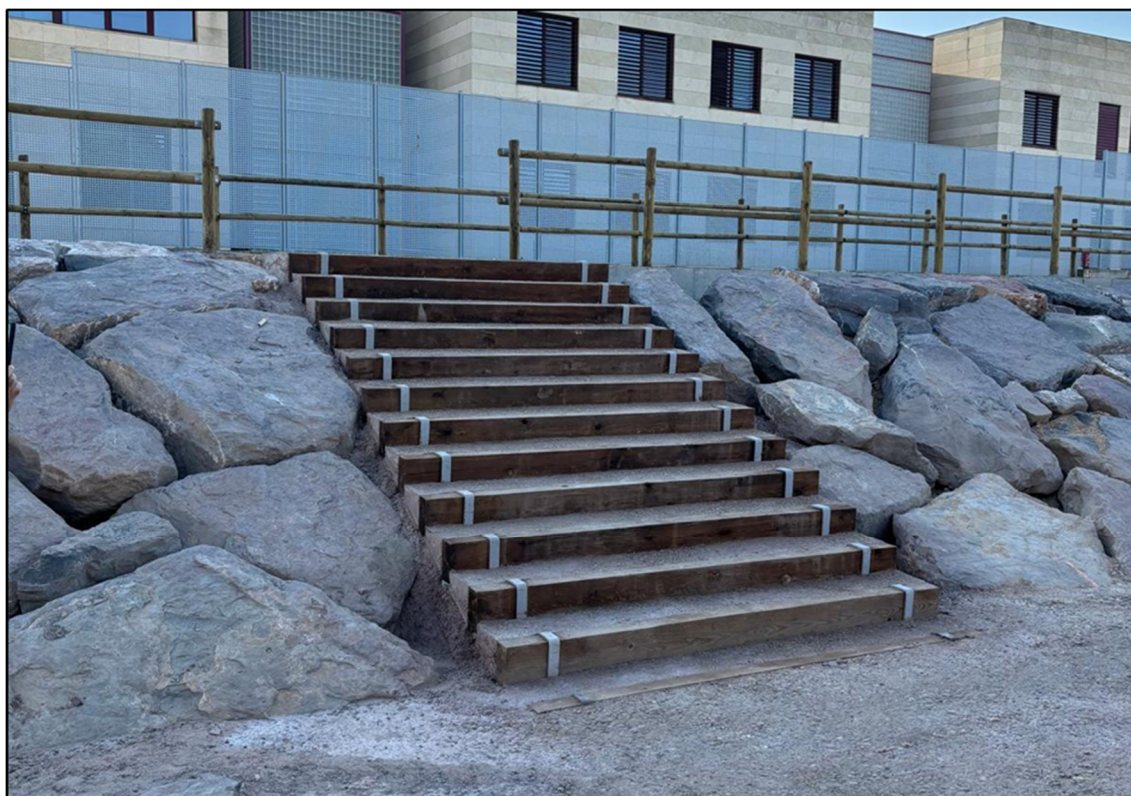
Escalera ejecutada en el Canal Perimetral del Barranco de la Muerte, fase I del proyecto.
